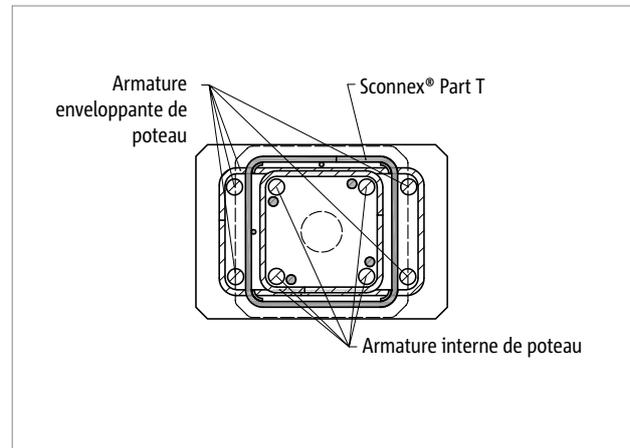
Schöck Sconnex® type P : pose de l'armature dans la zone 3– coupe transversale du poteau
